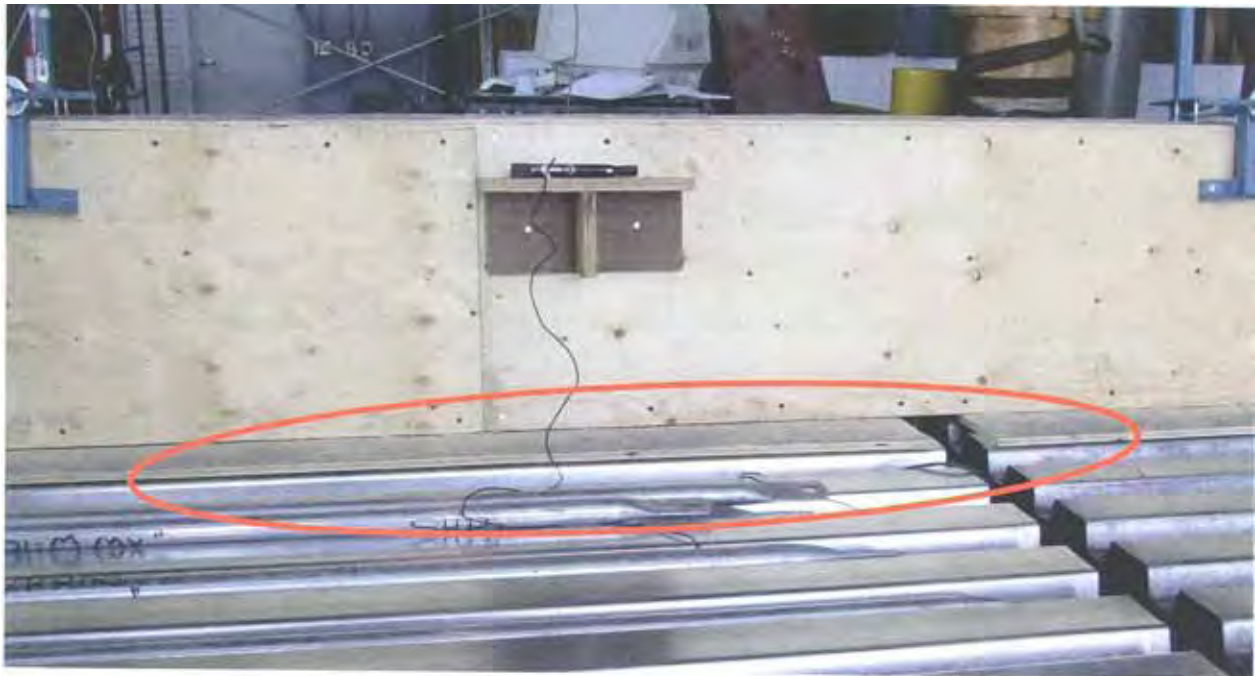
Soulèvement de la base du parapet à l'intérieur de la toiture au niveau des charges pour la configuration où le parapet est perpendiculaire aux poutrelles (série INSR, parapet flexible).
